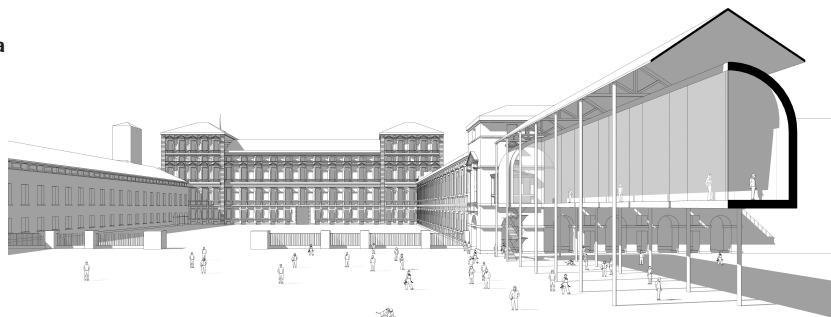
Vista prospettica dell'esplorazione progettuale 4.
